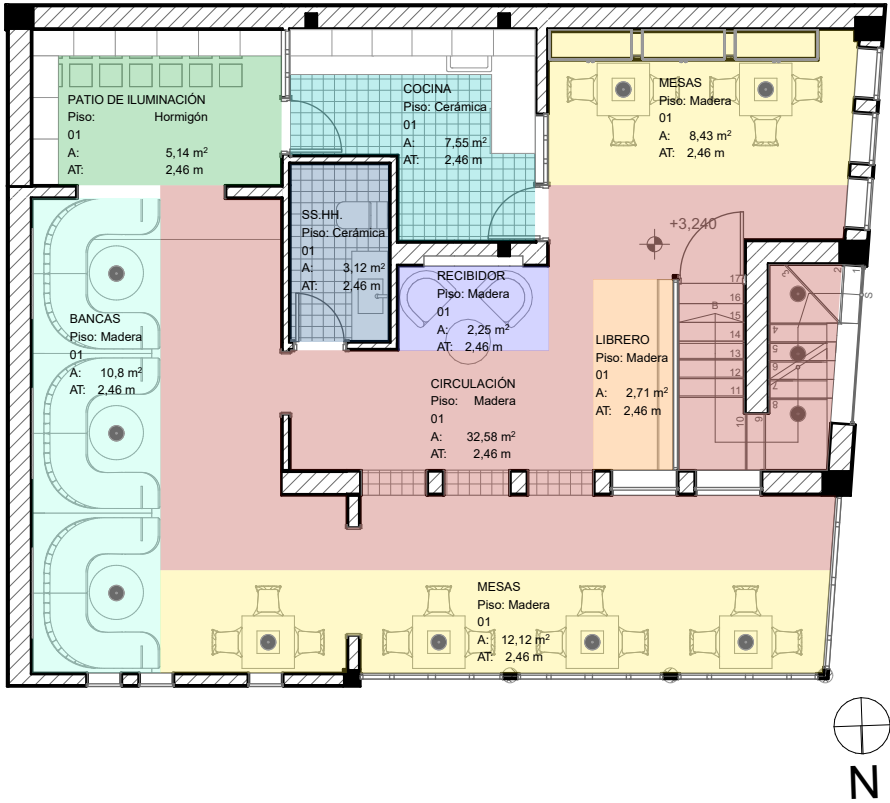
Organigrama de Planta Alta para Cafetería – Heladería / Autor, 2023.
